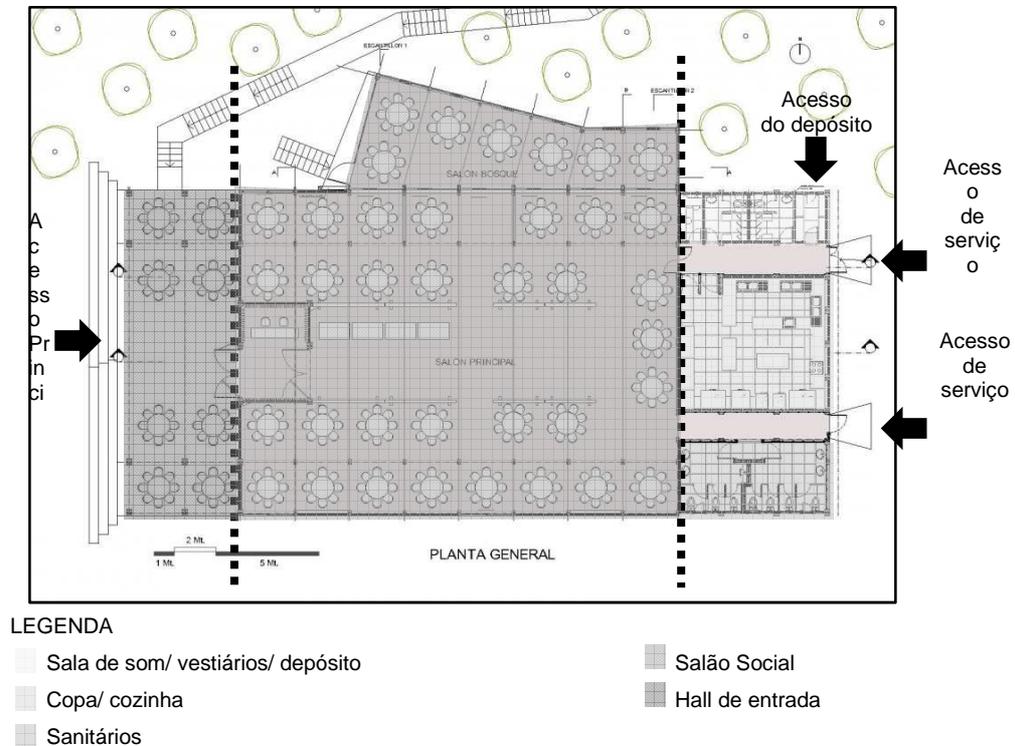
Planta Baixa Centro de Eventos Hotel El Parque
